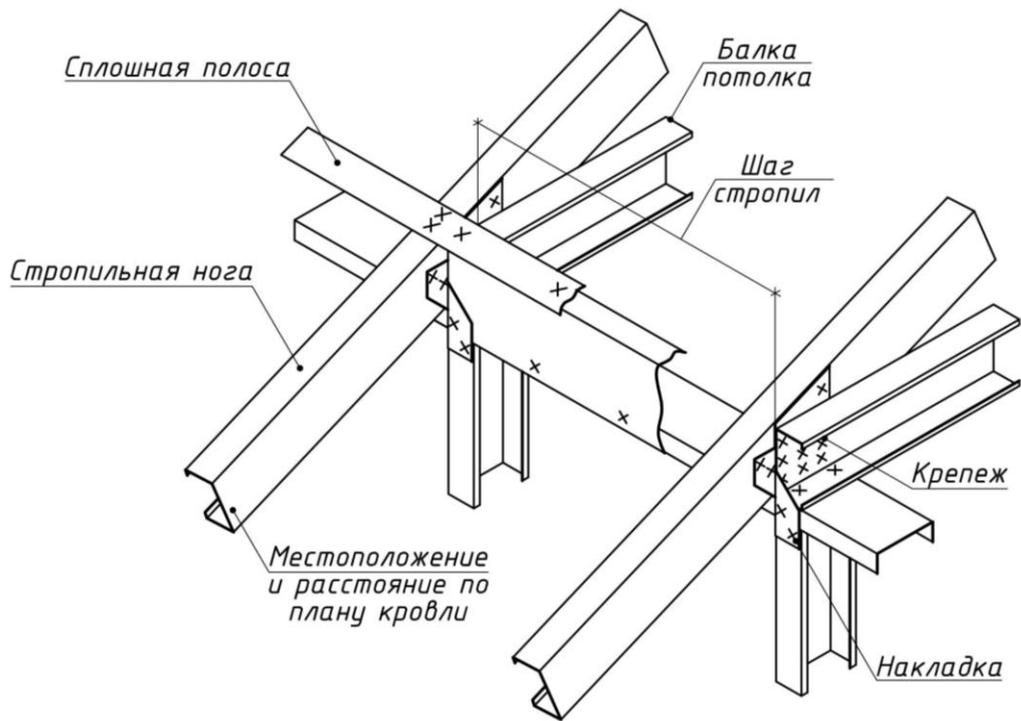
Узел К 11. Конструкция кровли в линию
